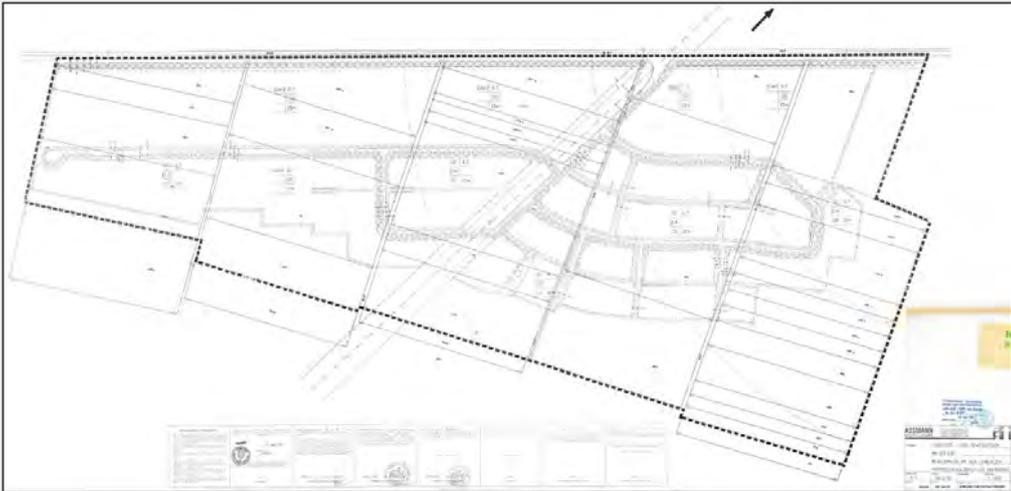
B-Plan „Nr. 17 - Erweiterung Industrie- und Gewerbepark an der B 87“
